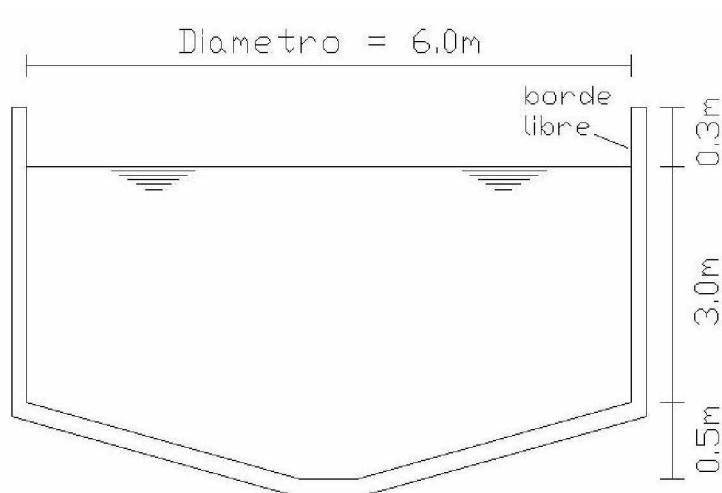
Sección del digestor de lodos de la Planta N°3
